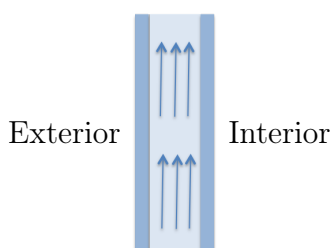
Esquema de fachada compuesta por: Elemento exterior ligero, elemento interior ligero.
